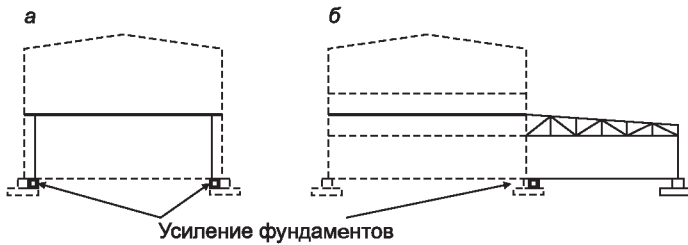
Встройка междуэтажного перекрытия и пристройка помещений
